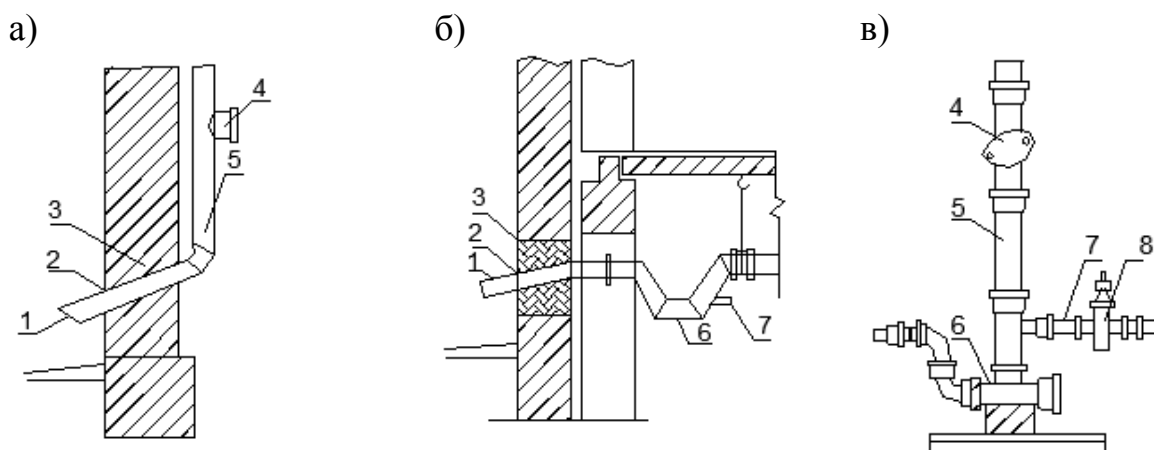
Открытые выпуски водостоков: 1 – труба выпуска; 2 цементная стяжка; 3 – слой теплоизоляции; 4 – ревизия; 5 – стояк; 6 – гидрозатвор; 7 – труба для отвода талых вод; 8 – пробочный кран.
